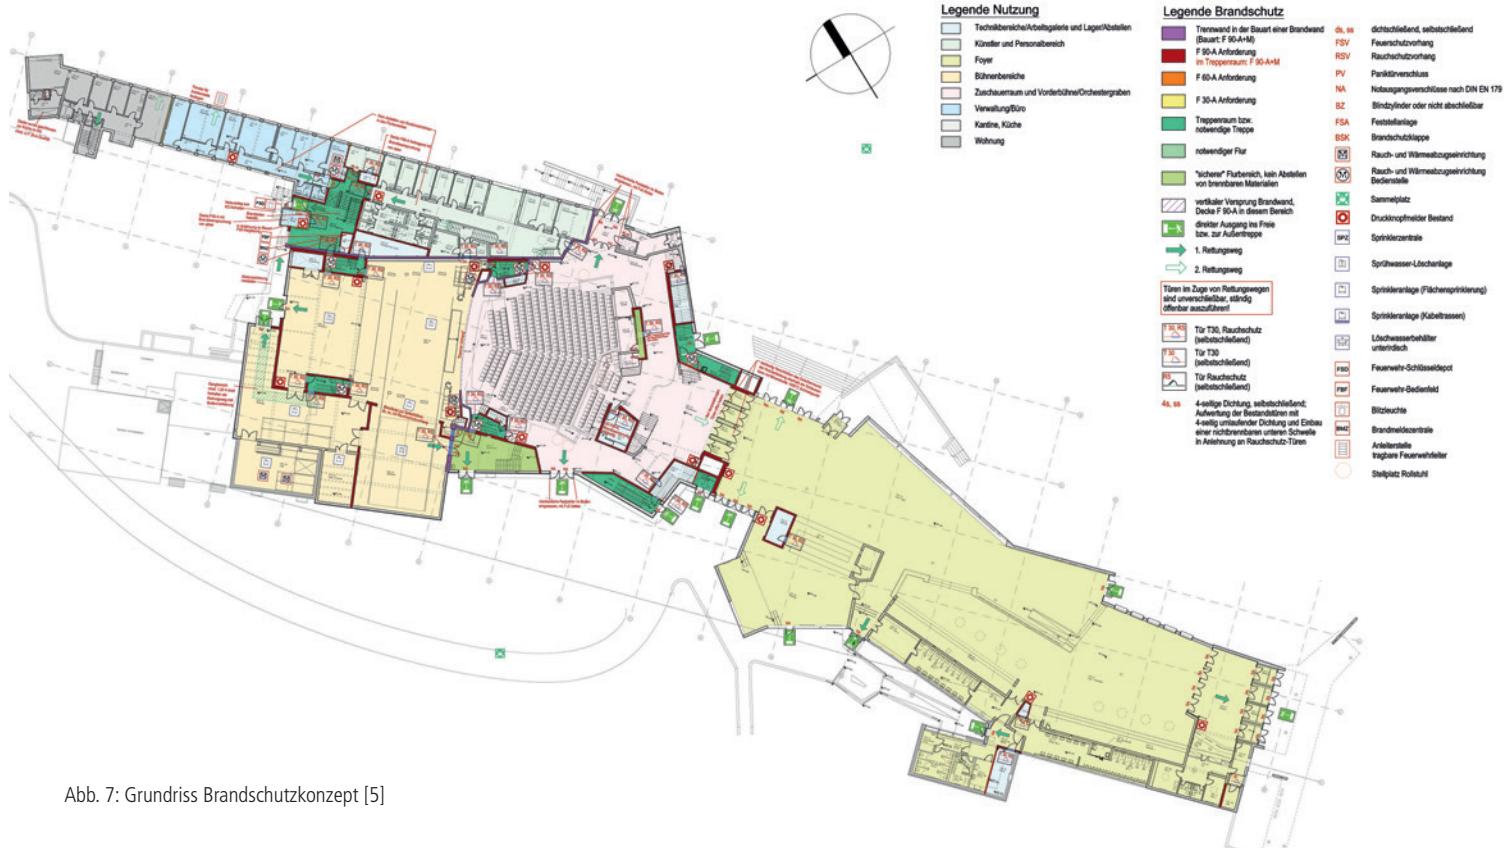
Grundriss Brandschutzkonzept [5]
